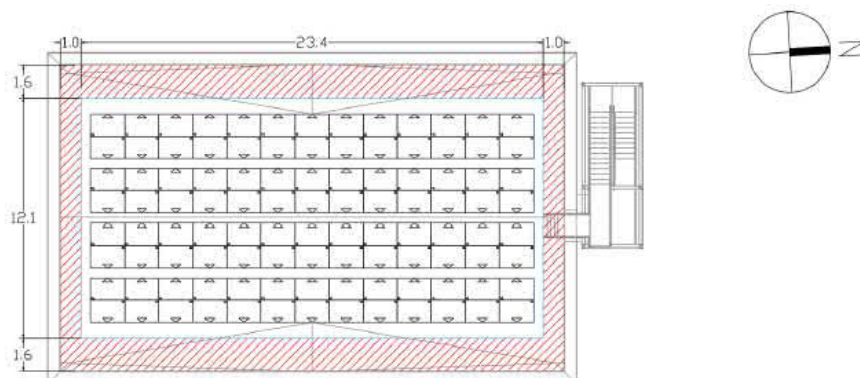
Dachfläche S-1, 104 Module, 41.6 kWp, Neigung 10°
